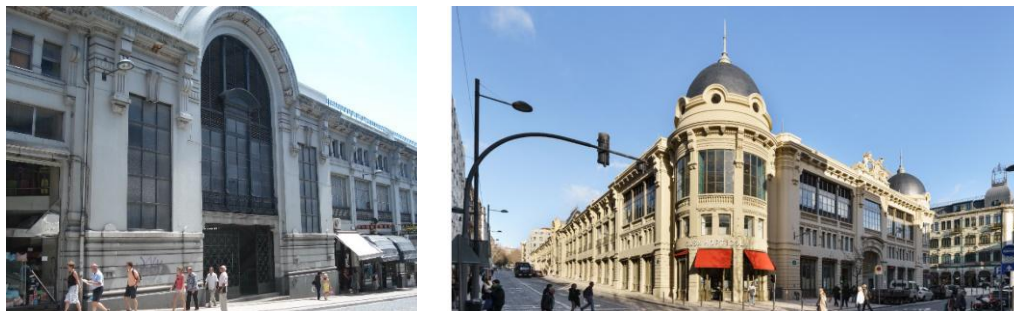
Fachadas rebocadas do Mercado do Bolhão – Antes e após a reabilitação.
